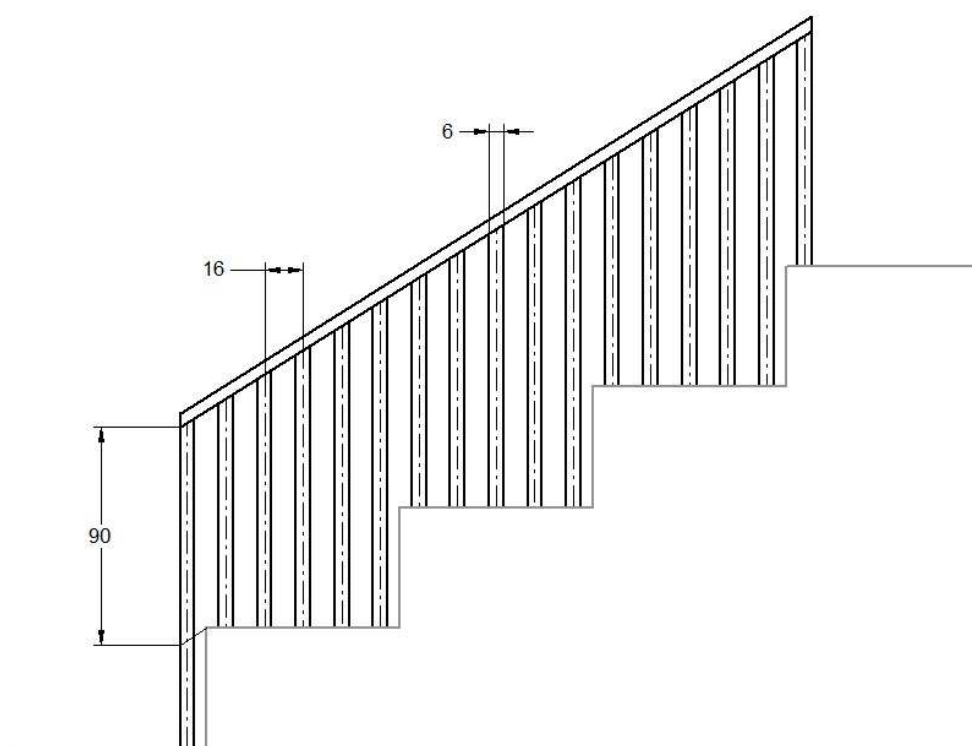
Configuración y dimensiones de la barandilla (dimensiones en cm)
